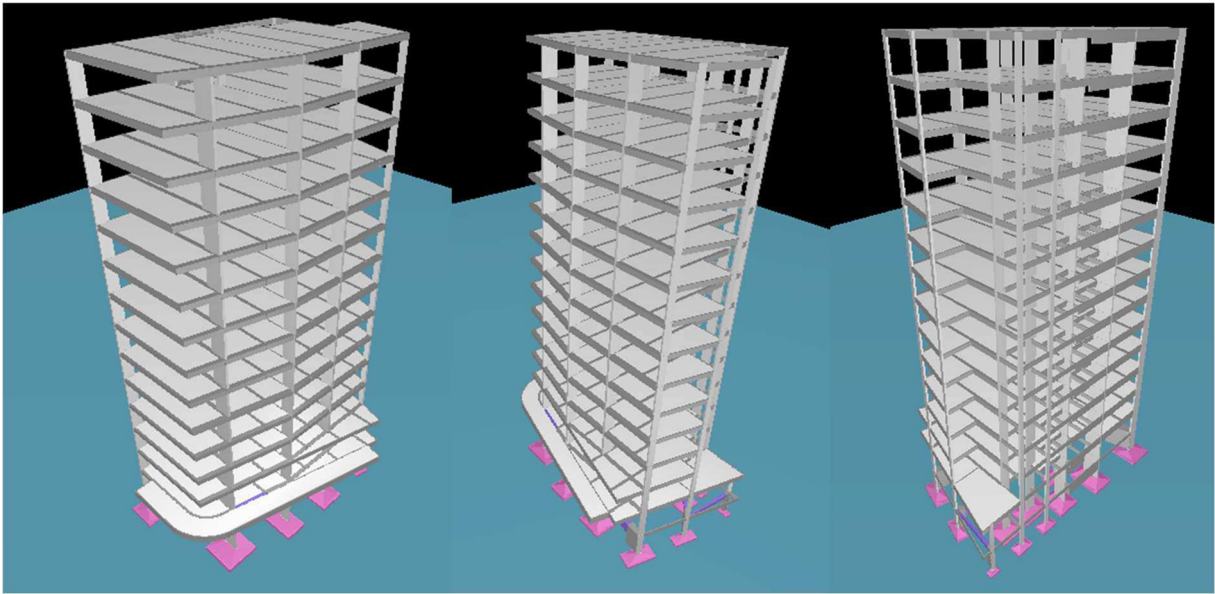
Lançamento estrutural das vigas e lajes do pavimento tipo
